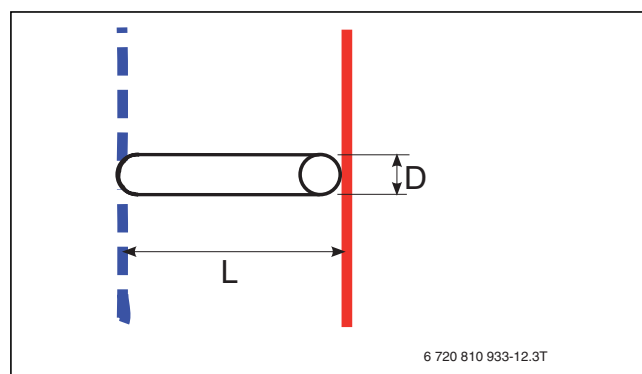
Bypass Detailansicht (→ [1] Abb. 2 und 3)
